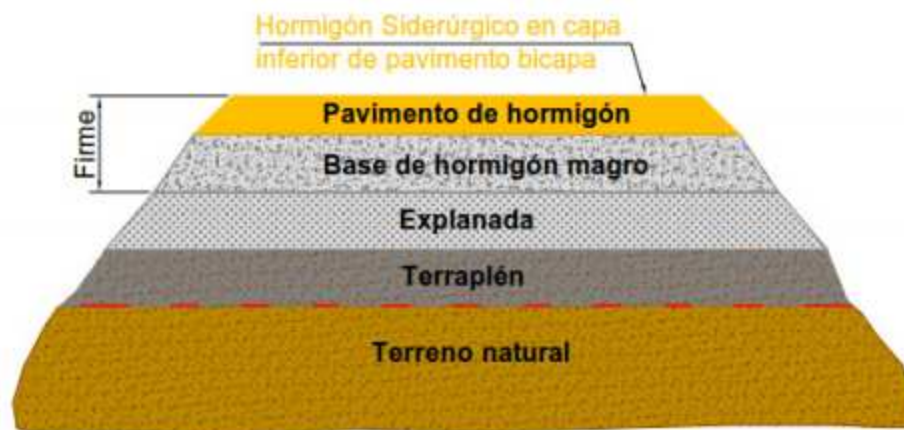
Capa inferior de pavimento hormigón bicapa [18]
